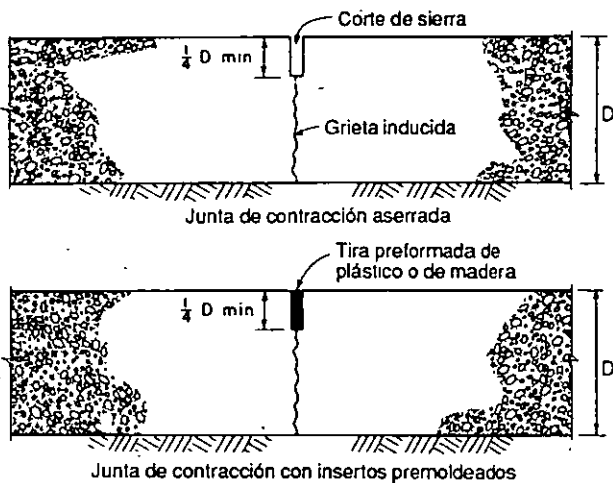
Las juntas de contracción aseguran el movimiento horizontal en el plano de una losa o de un muro e inducen el control de los agrietamientos provocados por la contracción por secado.
